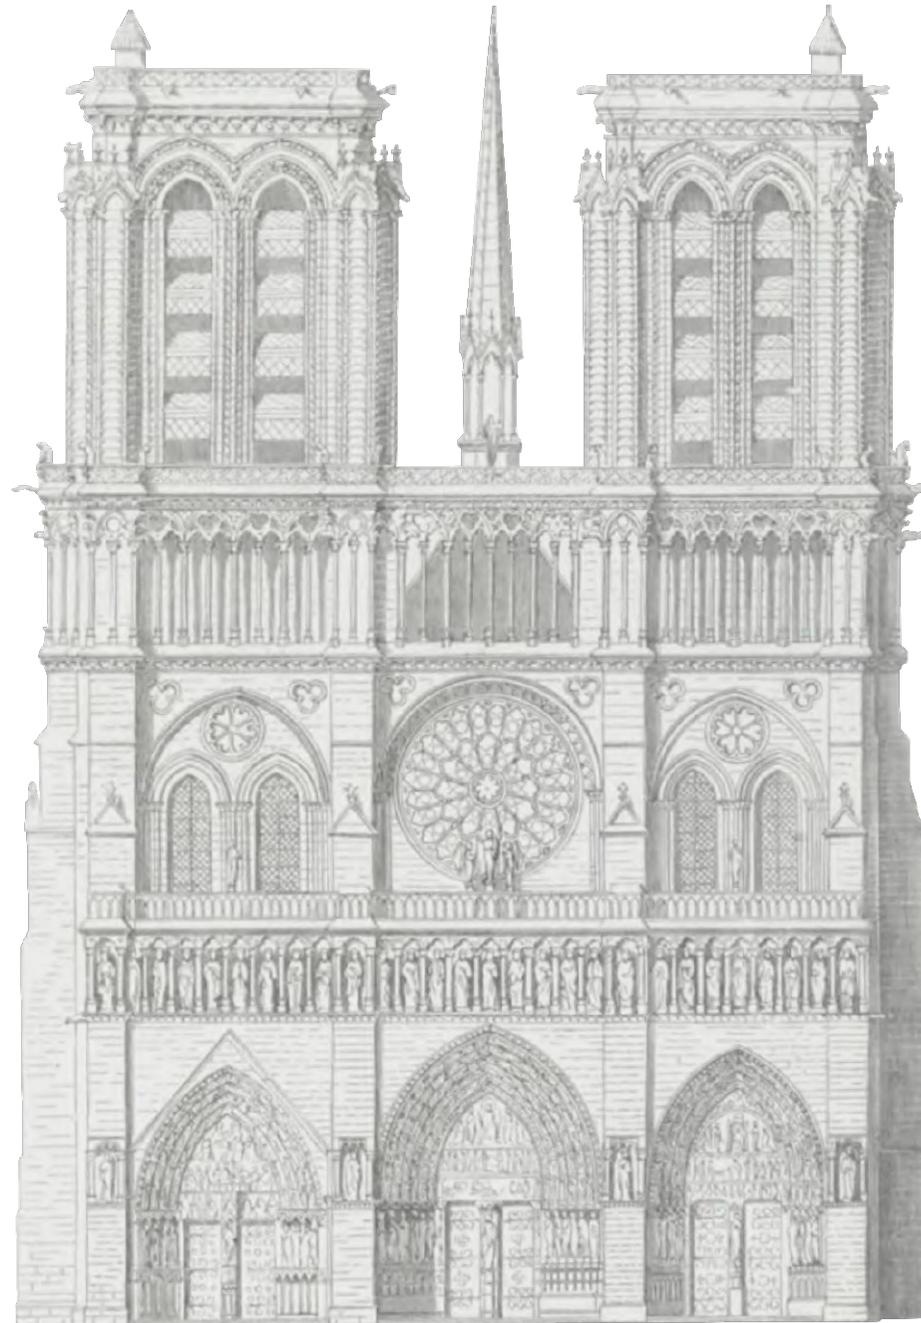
Anexo 01. Sección detalle de la fachada occidental (Fuente: Viollet-le-Duc, Lassus, 1853)
